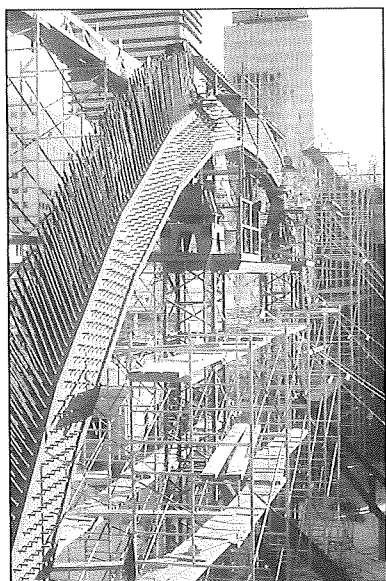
VISTA DE LA ESTRUCTURA DEL ARCO DE TORRE PICASSO
